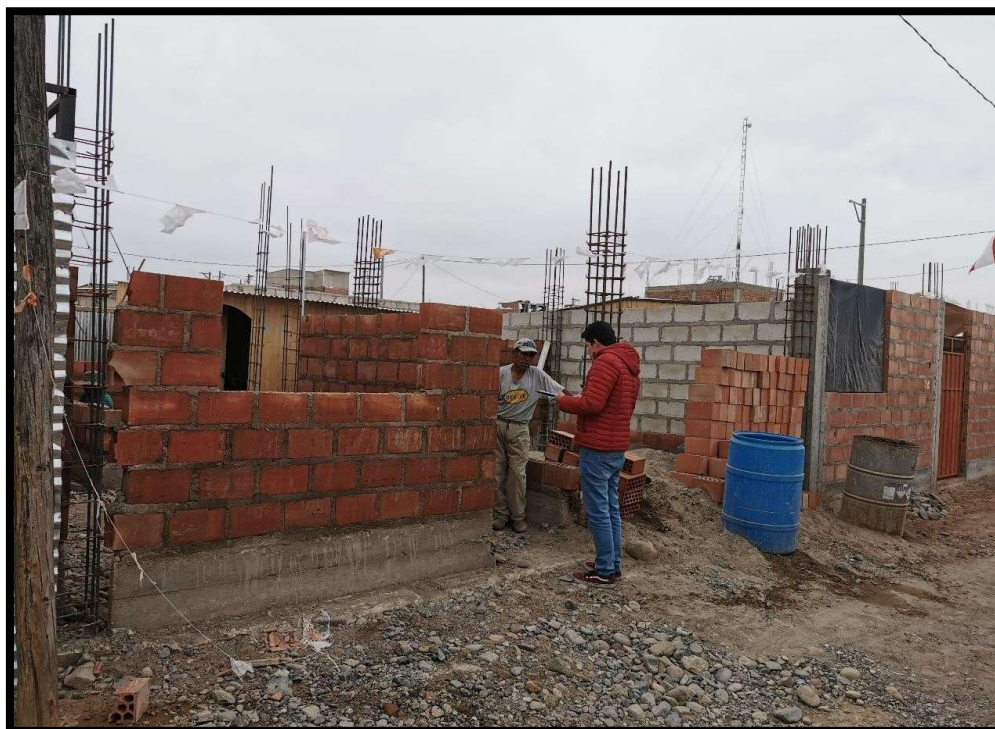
encuesta a propietario de construcción de módulo de vivienda.
